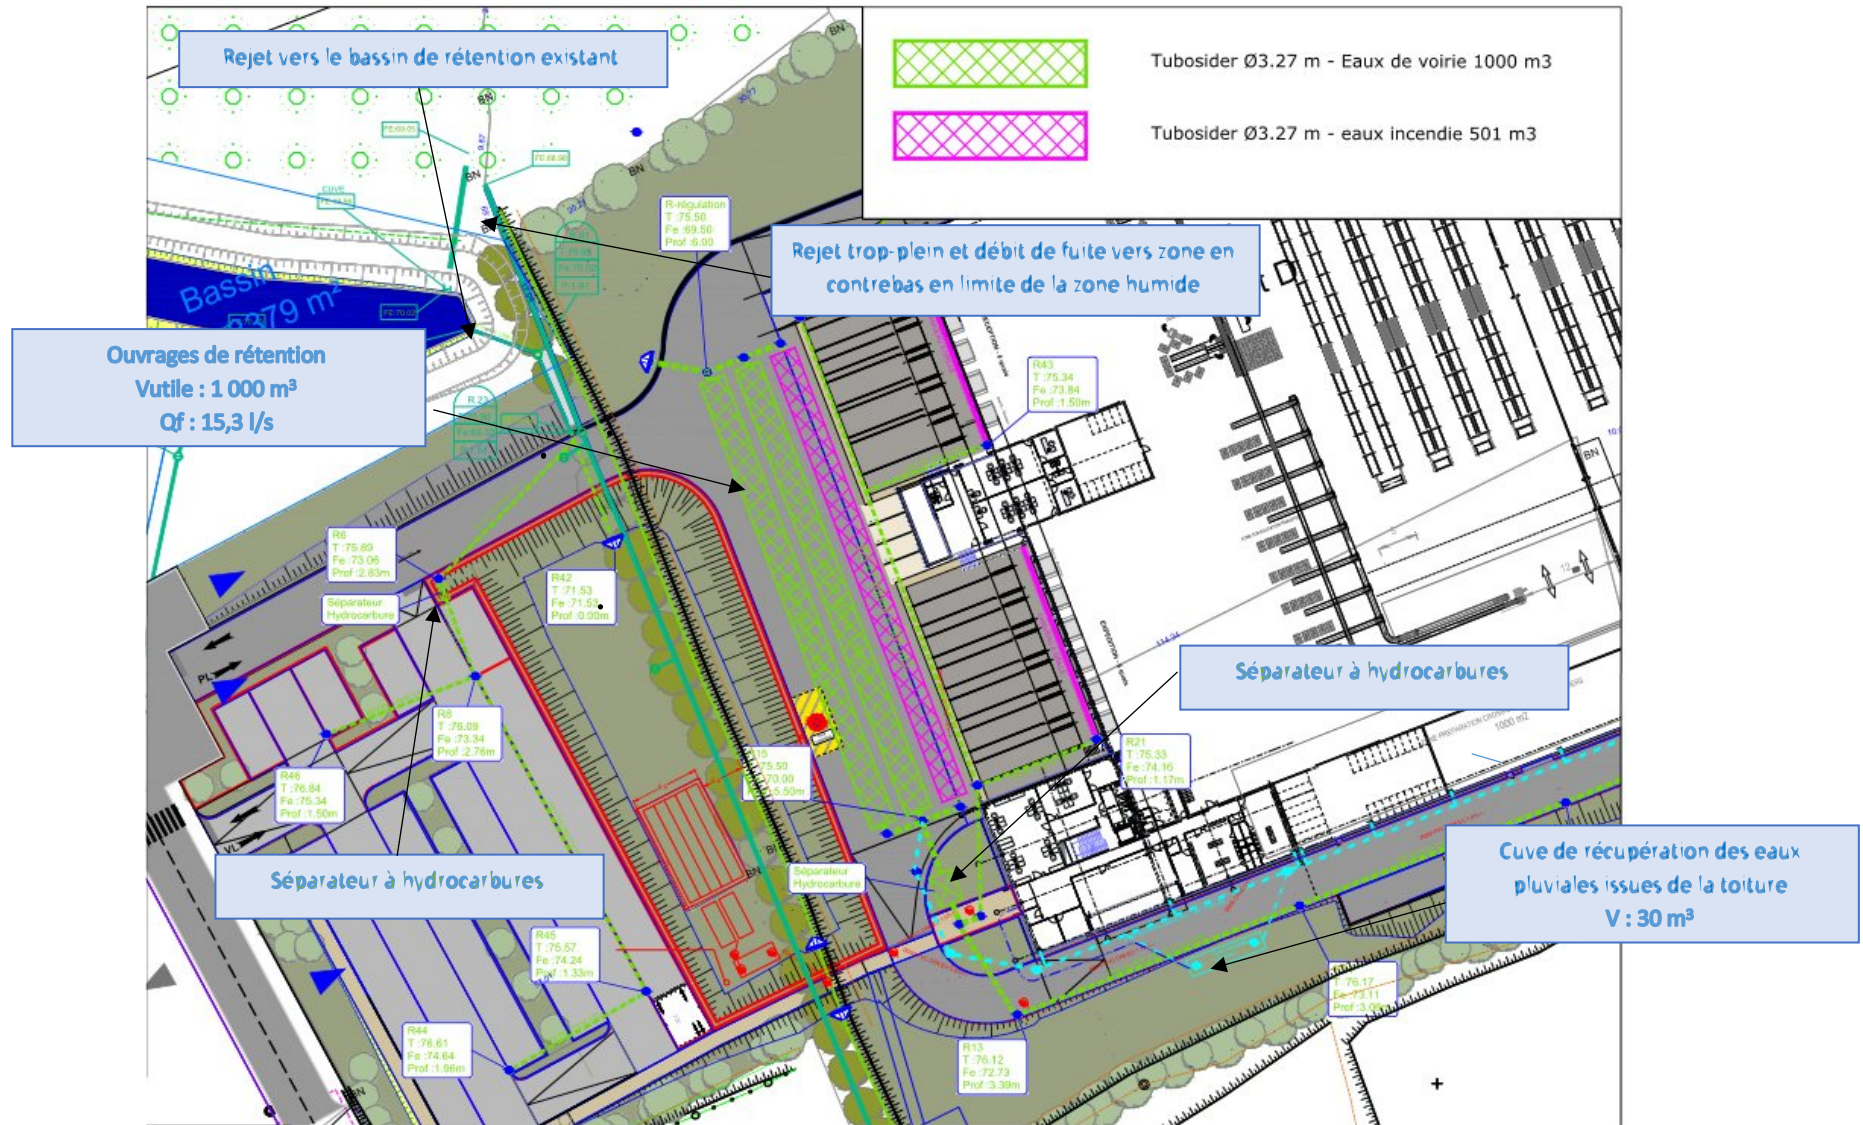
Plan des ouvrages de gestion des eaux pluviales proposés
